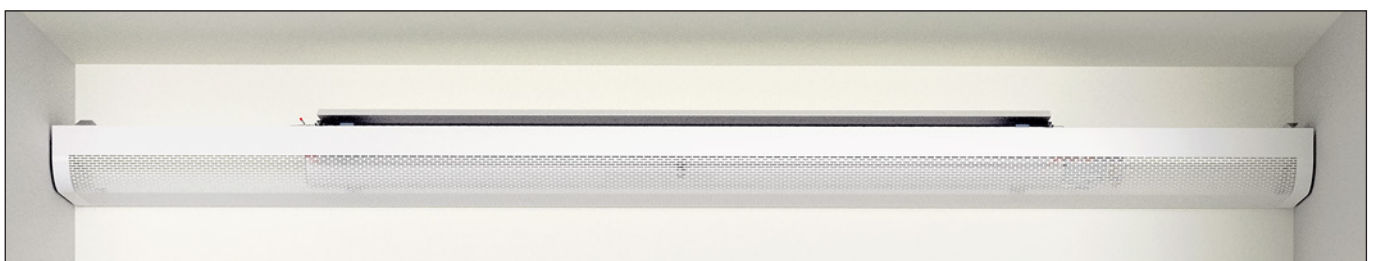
Plafond XD an der Wand montiert mit Abstand zur Decke (FW).
